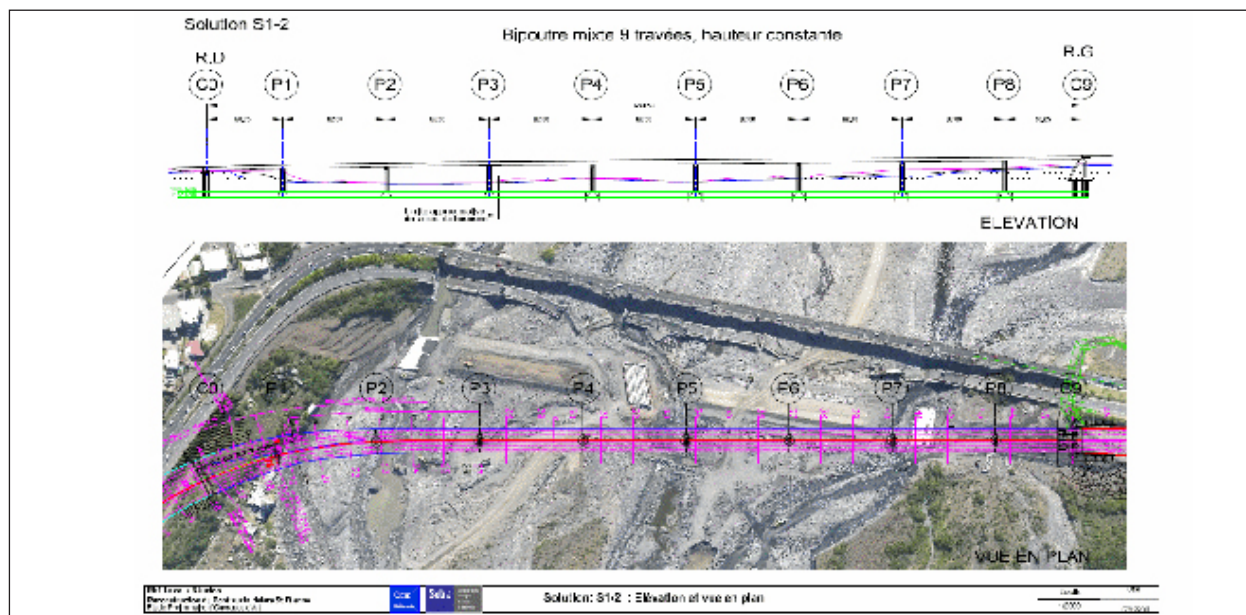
Élévation et vue en plan du projet de l'ouvrage
